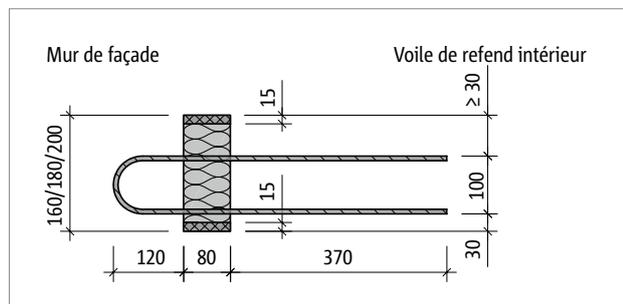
Schöck Rutherma® T type RF : vue en plan
